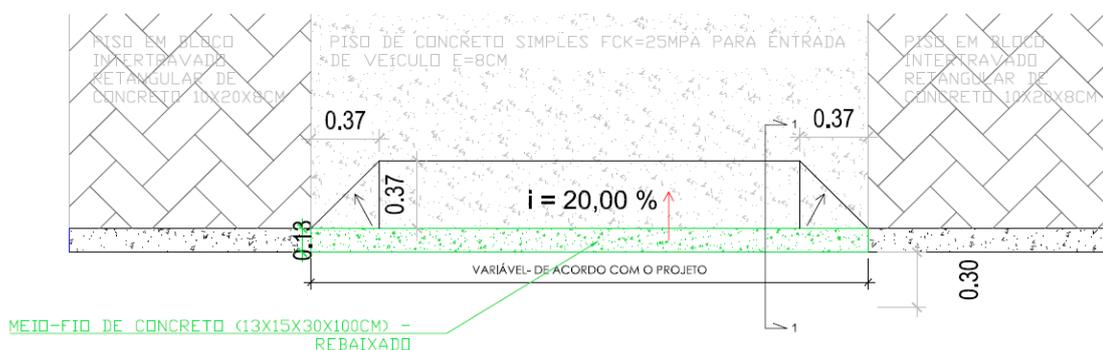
Detalhe construtivo em planta baixa esquemática da rampa de garagem de veículos leves a executar na calçada de piso intertravado do lado esquerdo da Rua B do bairro COHAB
